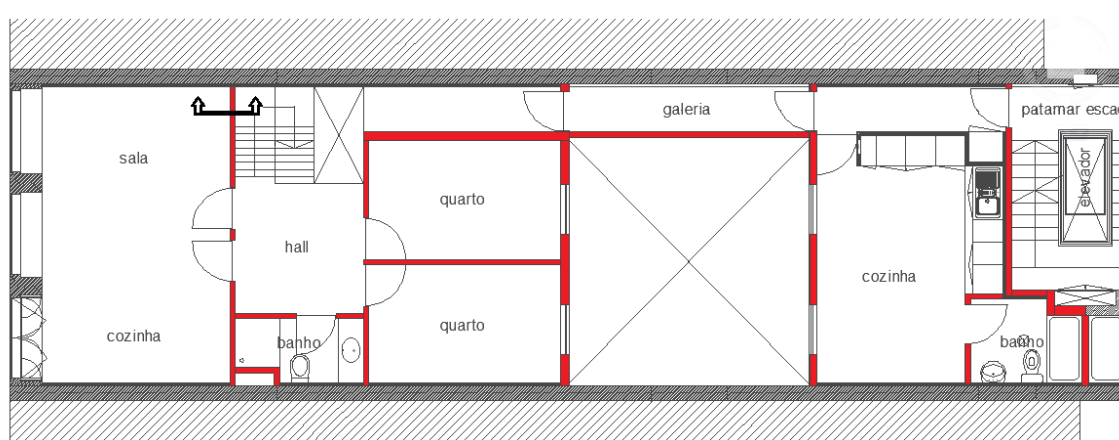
Marcação da zona de corte da parede divisória interior na planta (Adaptado das peças desenhadas do Edifício do Caso de Estudo)
